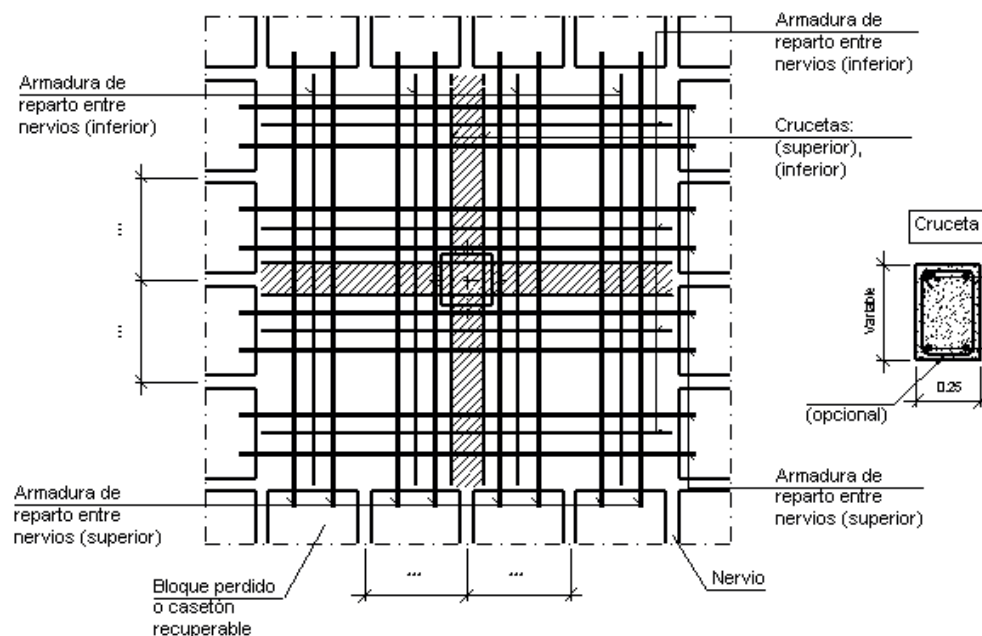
Planta tipo del ábaco de forjado reticular con casetones recuperables
